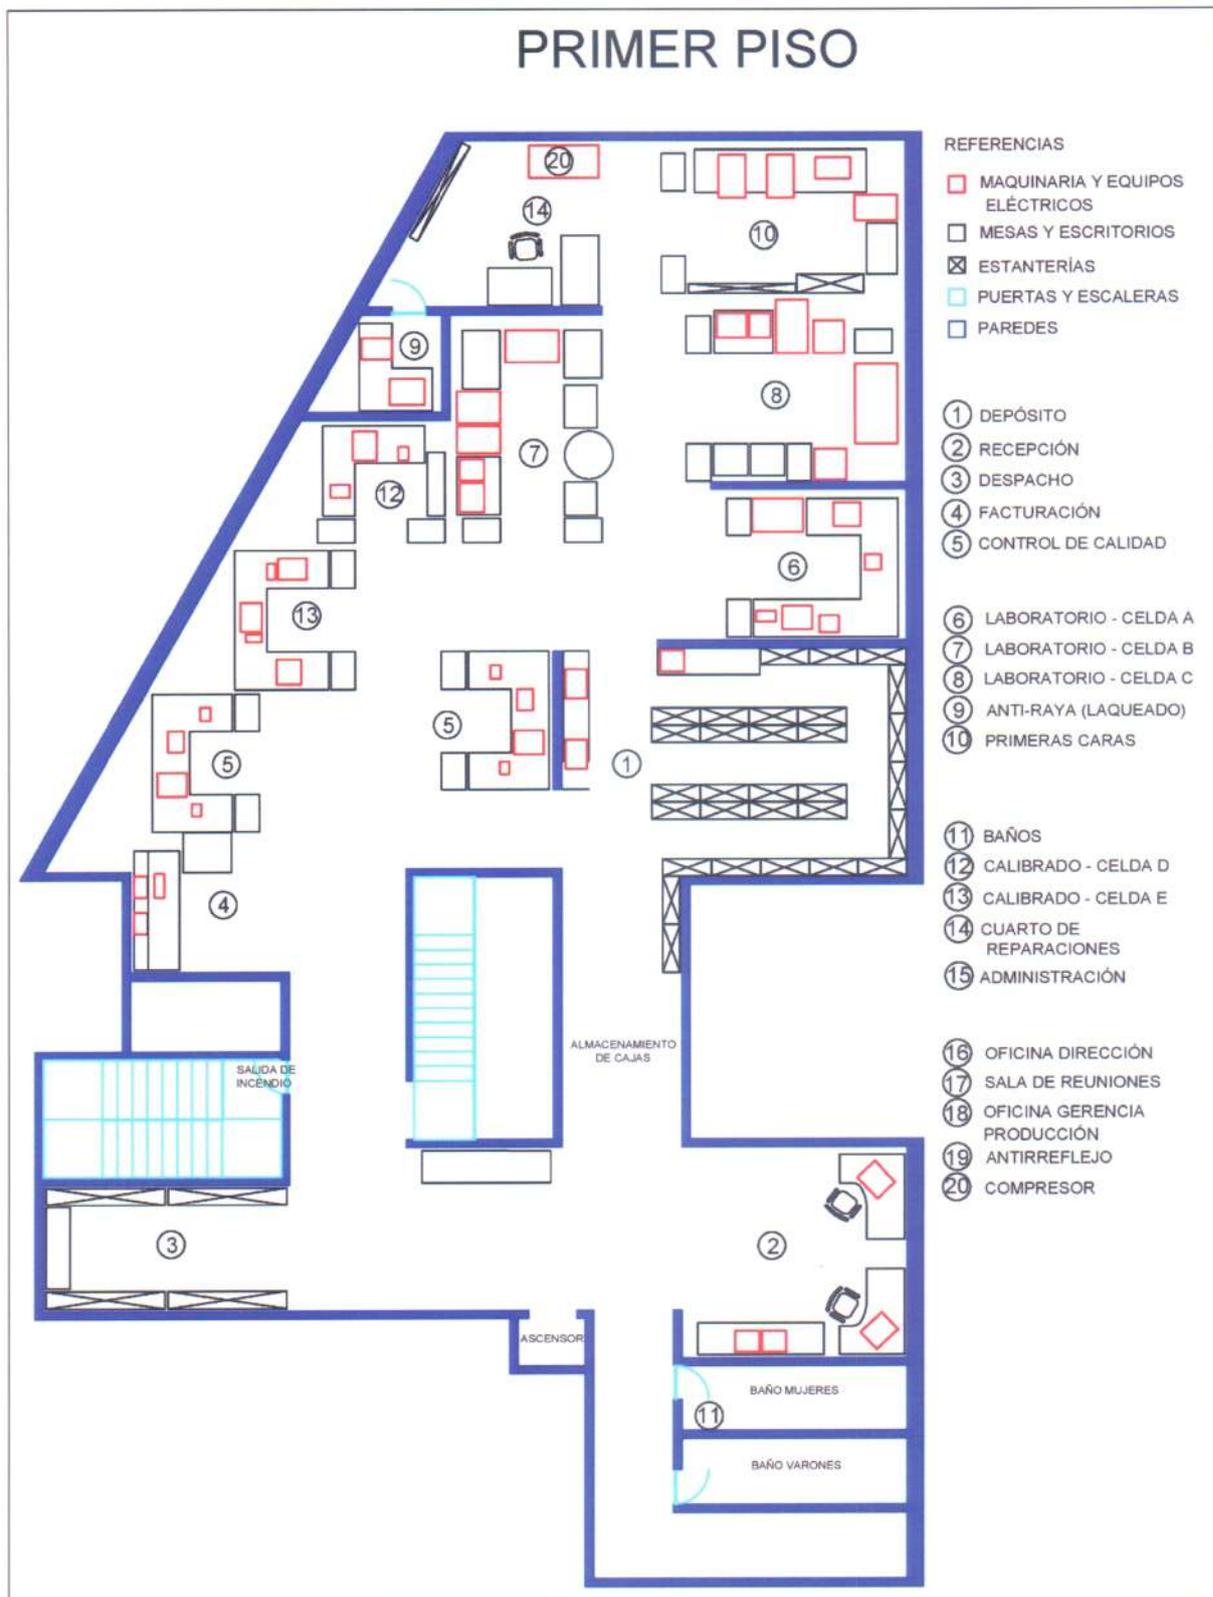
Plan maestro Laboratorio de Lentes X - Primer piso (Instalación propuesta).
